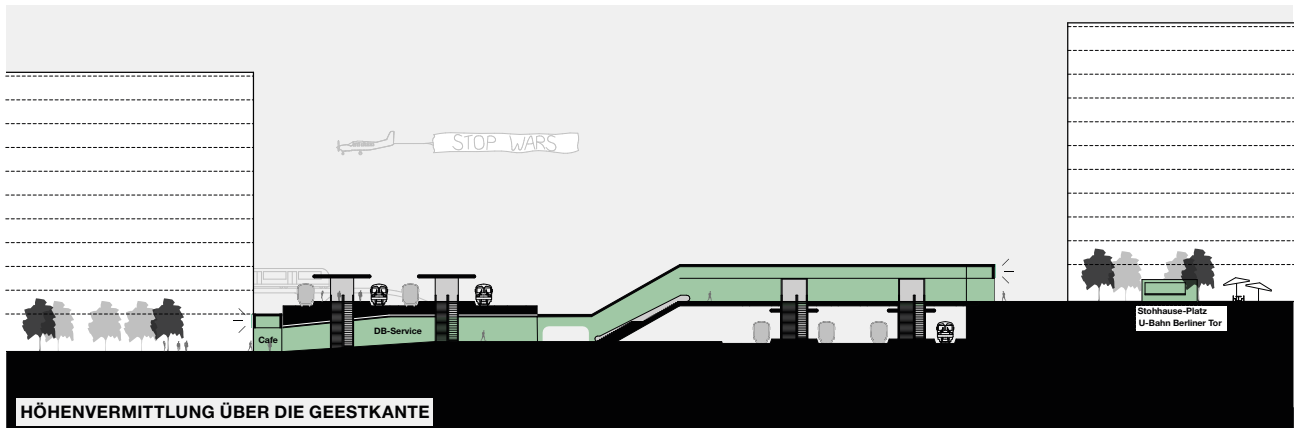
Querschnitt der in Troglage liegenden Bahnstrecke Lübeck - Hamburg im Rahmenplan Berliner Tor
